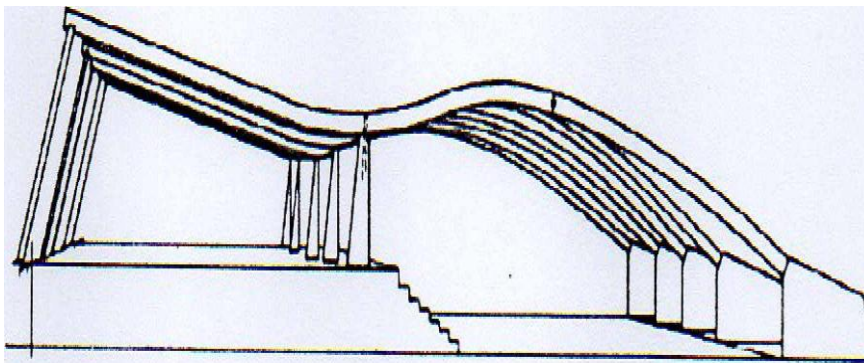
les poutres droites (portée de 20 à 40 m et plus entre appuis).
